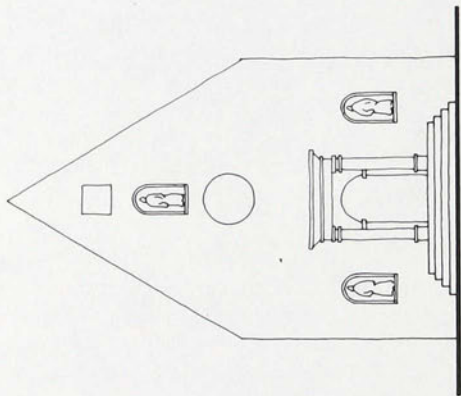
Façade construite en 1723 par Jean Mailloü, architecte.
